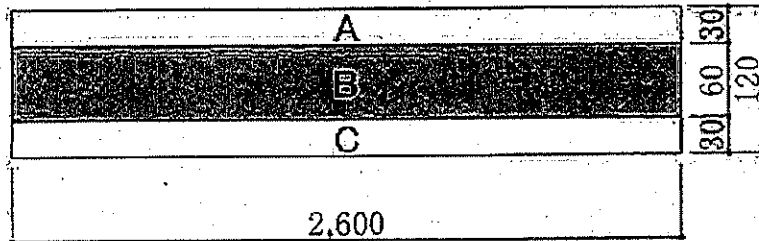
含水率測定位置 (平面図: 外層はヒキ、内層はスギ)
